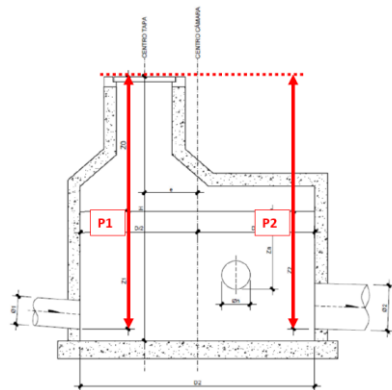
Vista en profundidad de entrada y salida de tuberías al interior de cámaras
